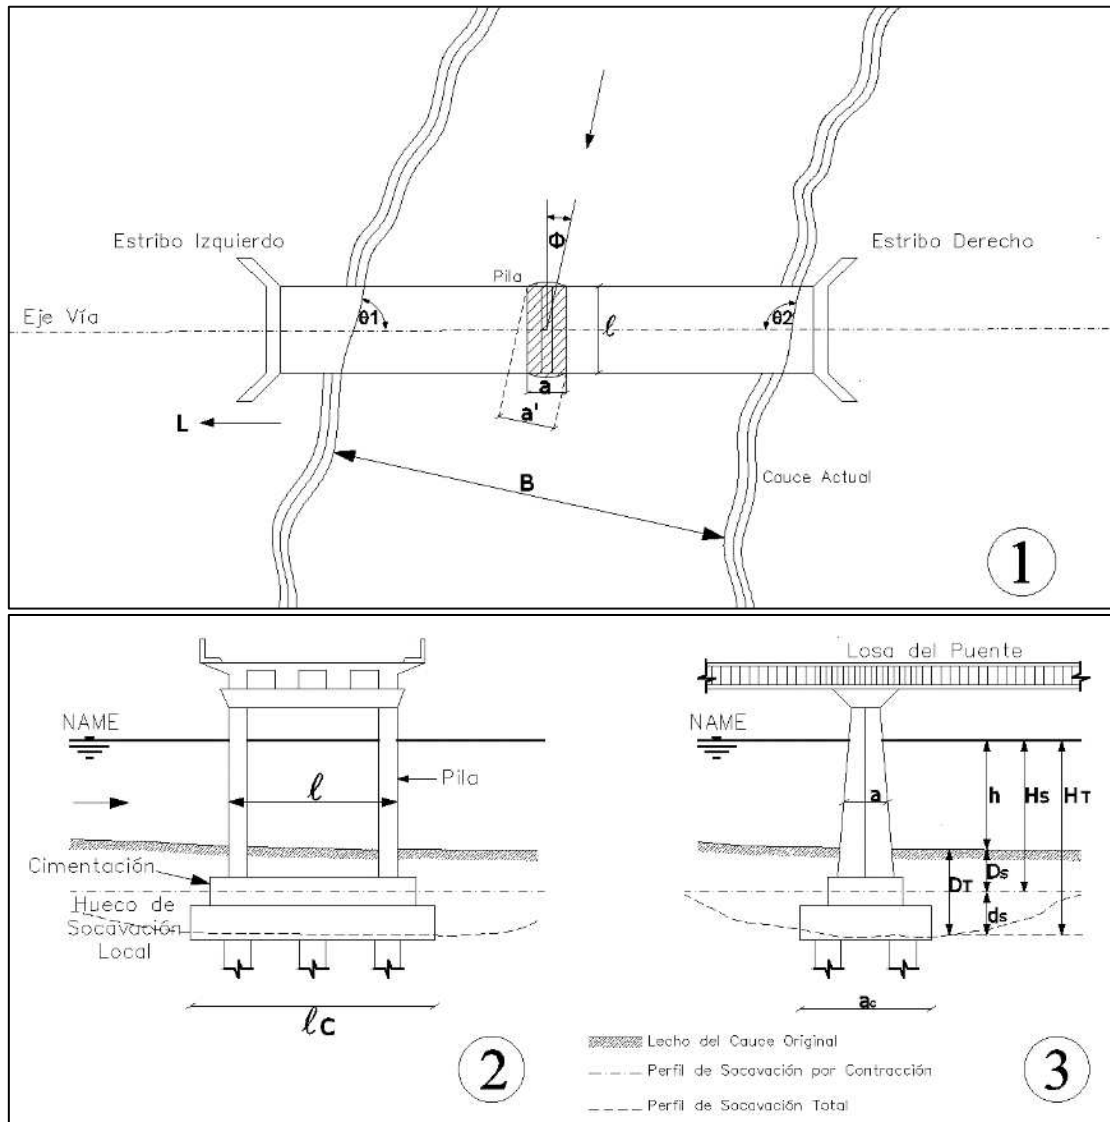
Nomenclatura Convencional para cálculo de socavación en puentes. 1) Vista en planta. 2) Vista longitudinal. 3) Vista Frontal.
